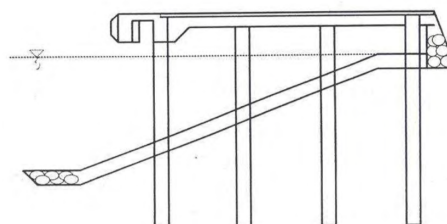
16. Bentuk Dermaga *Pier
